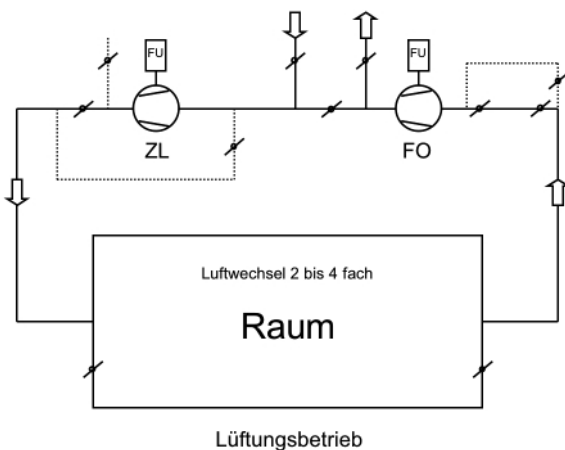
Anlagenschema einer Lüftungsanlage im Normalbetrieb
